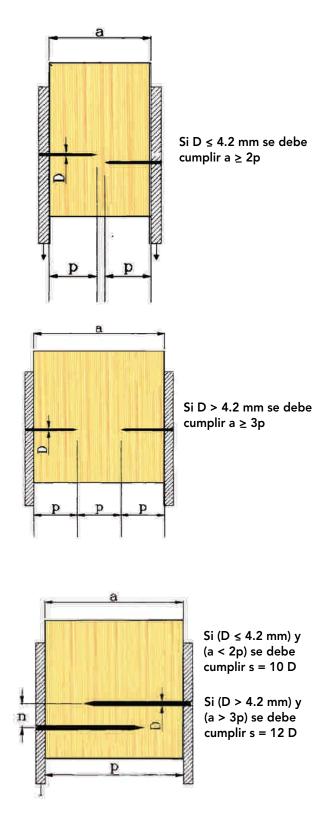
Uniones de placa de acero y madera con clavado sin disposición alternada.
